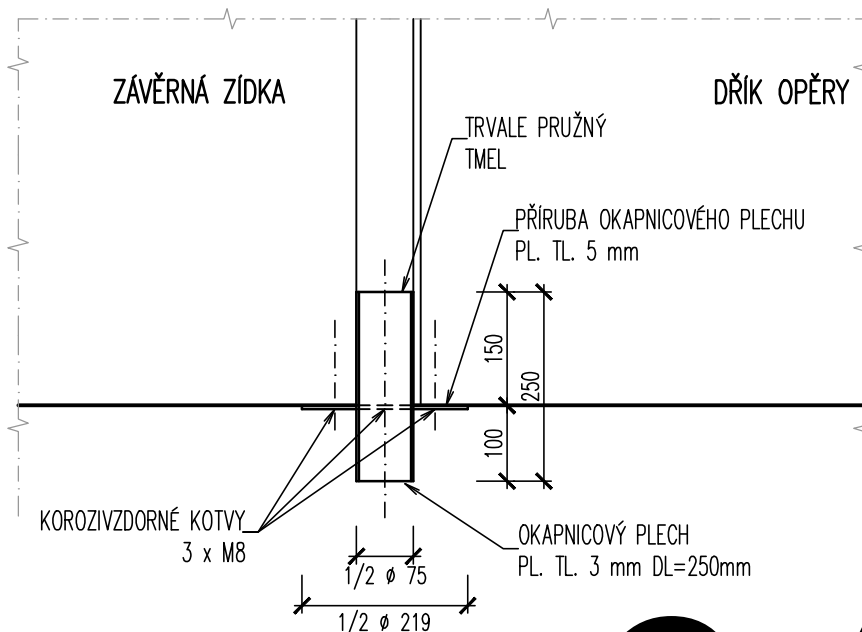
DETAIL OKAPOVÉHO PLECHU NA OKRAJI ÚLOŽNÉHO PRAHU 1 : 10
